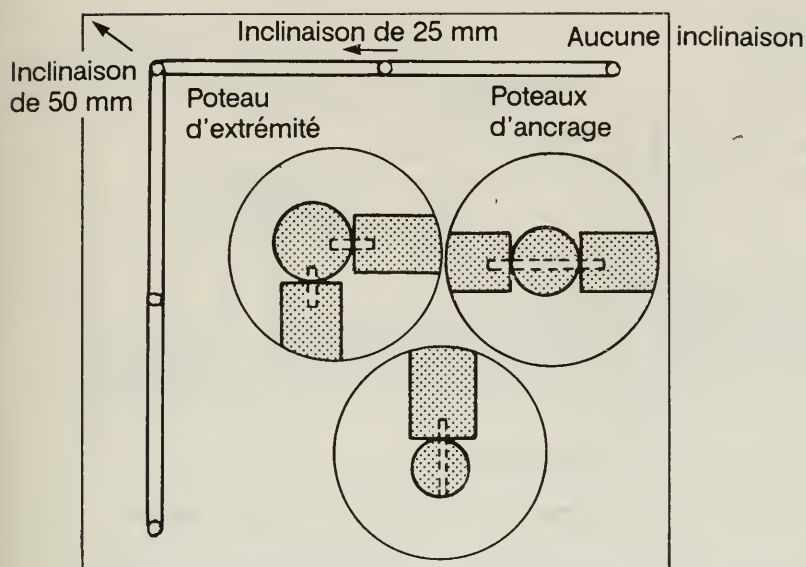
Assemblage d'ancrage de coin montrant le détail des joints avec chevilles.
